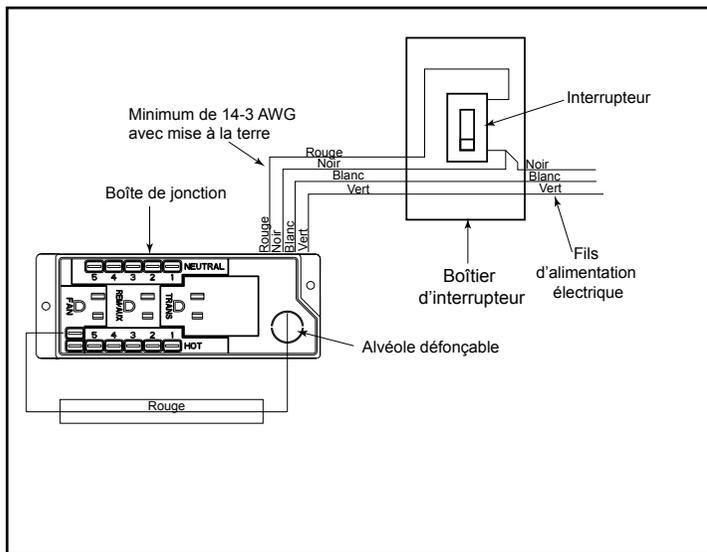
Boîte de jonction câblée à l'interrupteur mural ou BC10
